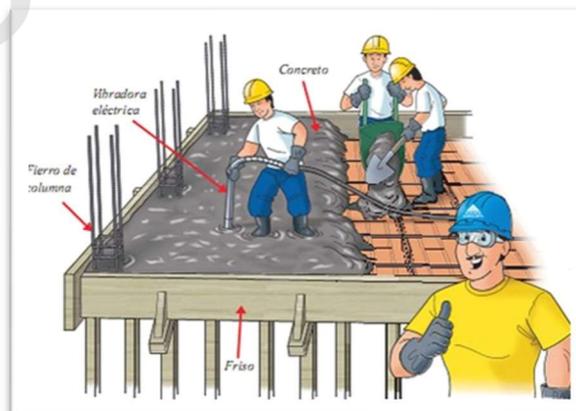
Vaciado de concreto sobre losa colaborante de ladrillos.
